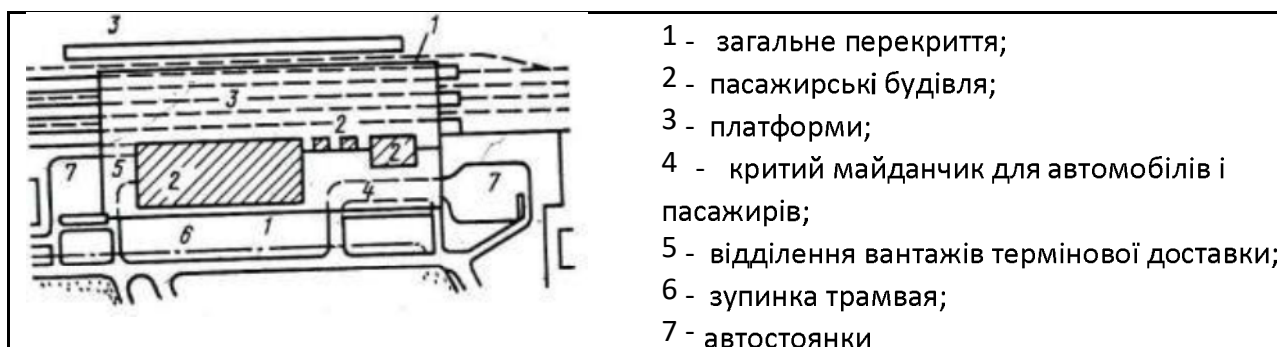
Варіант планування пасажирської станції Софія із загальним перекриттям будівлі вокзалу і платформ
